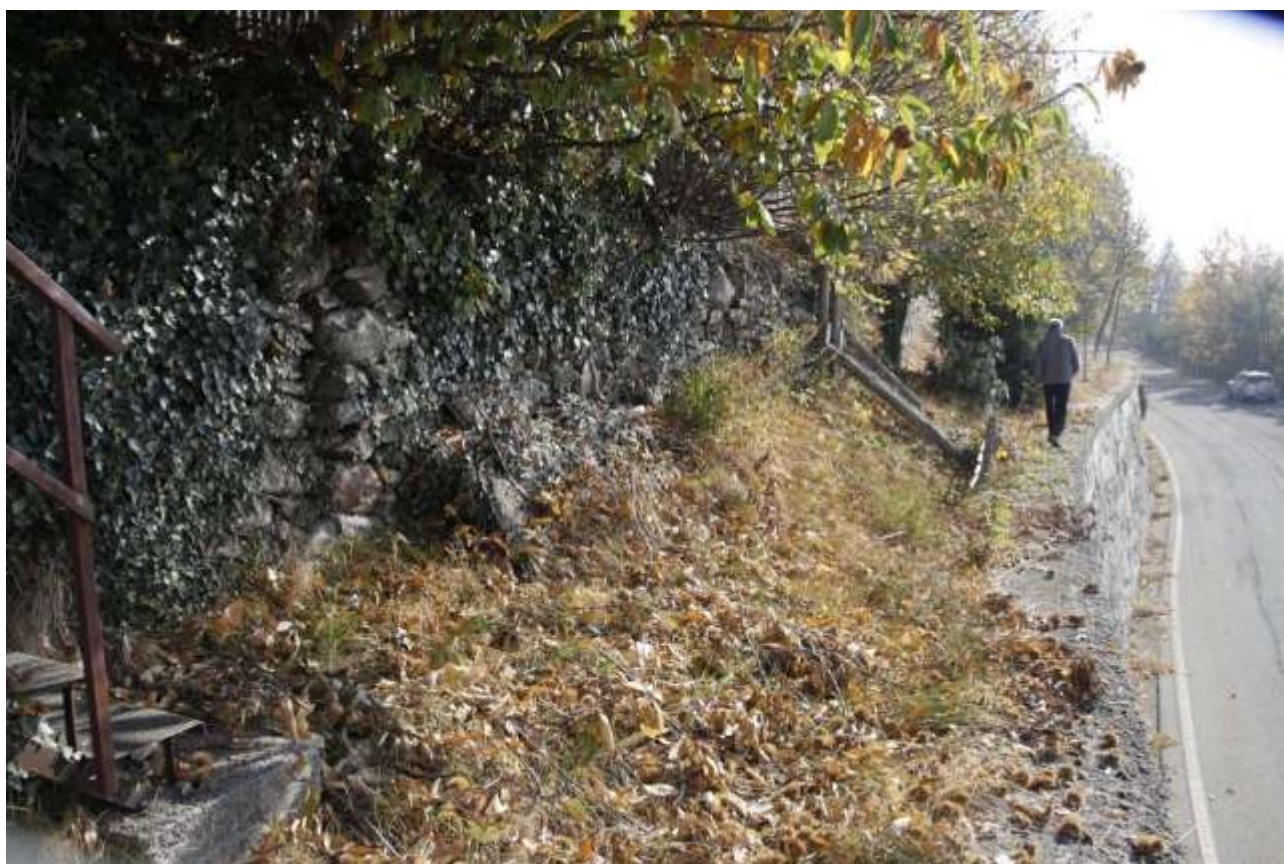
nella foto i contrafforti individuano il tratto centrale dell'intervento
